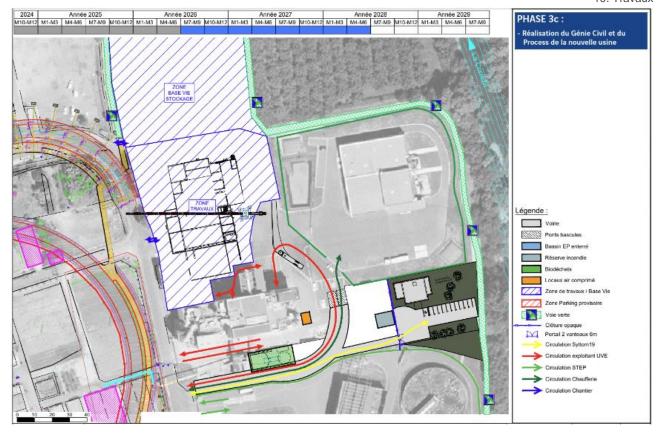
plans de circulation déconstruction des bureaux du SYTTOM et construction de la nouvelle UVE
